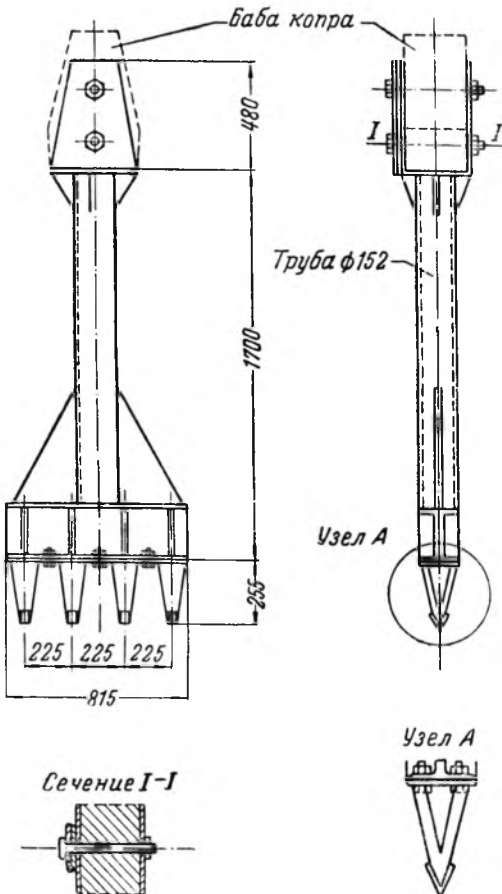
Конструкция приспособления к самоходному копру для рыхления мерзлого грунта.
